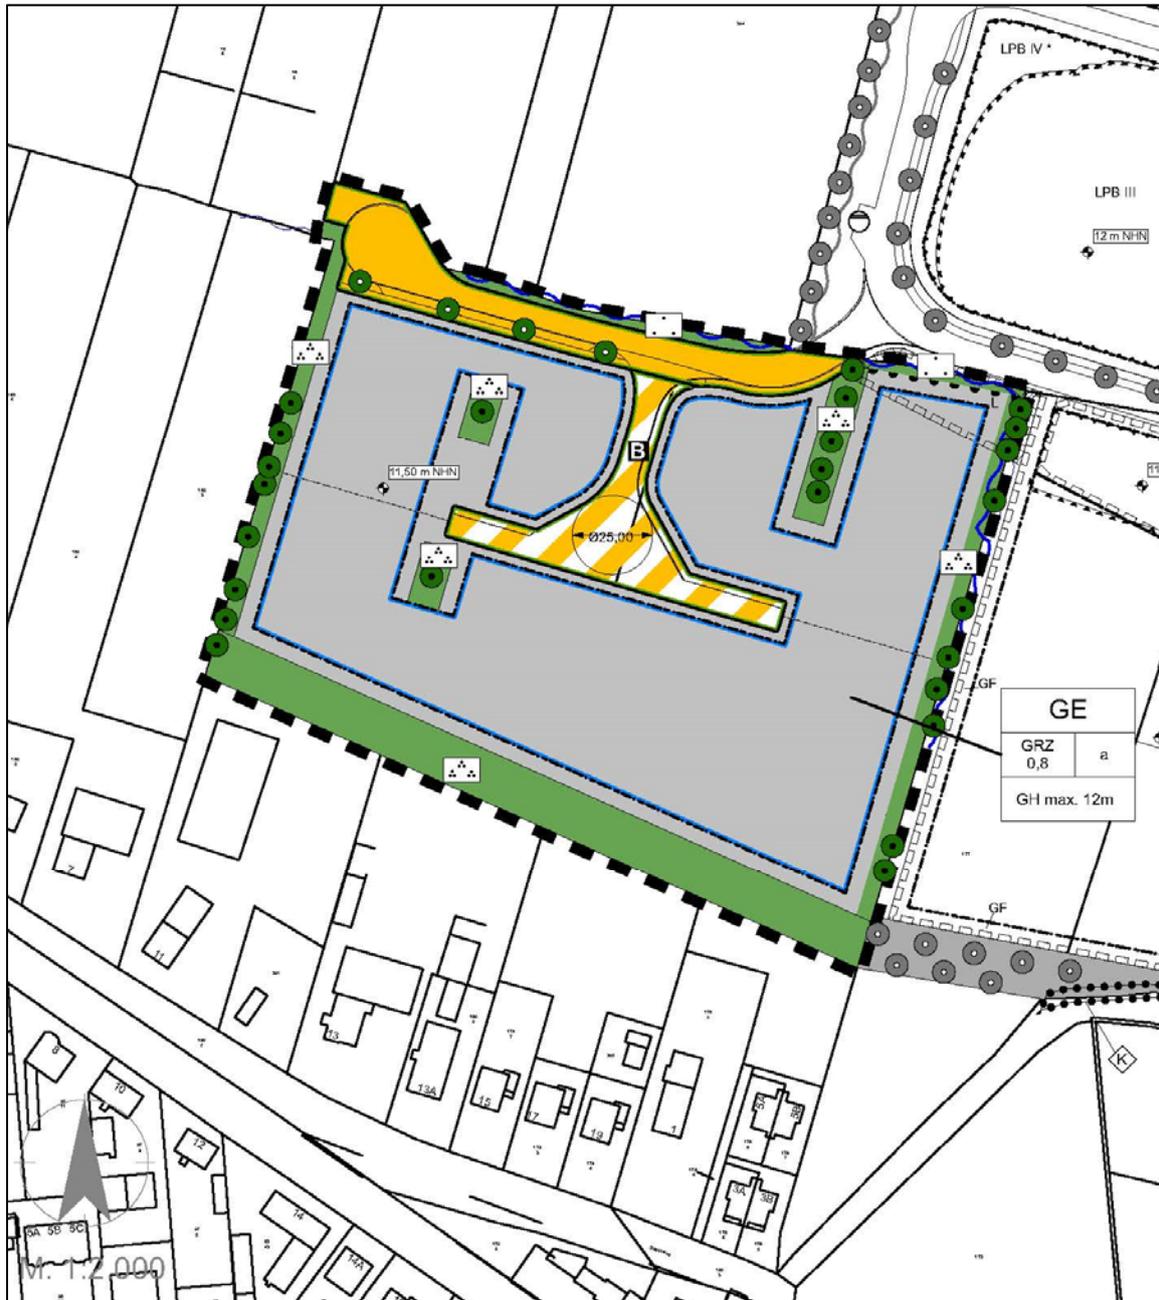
Entwurf B-Plan Nr. 61, Bad Bramstedt (Stand 01.09.2020)
